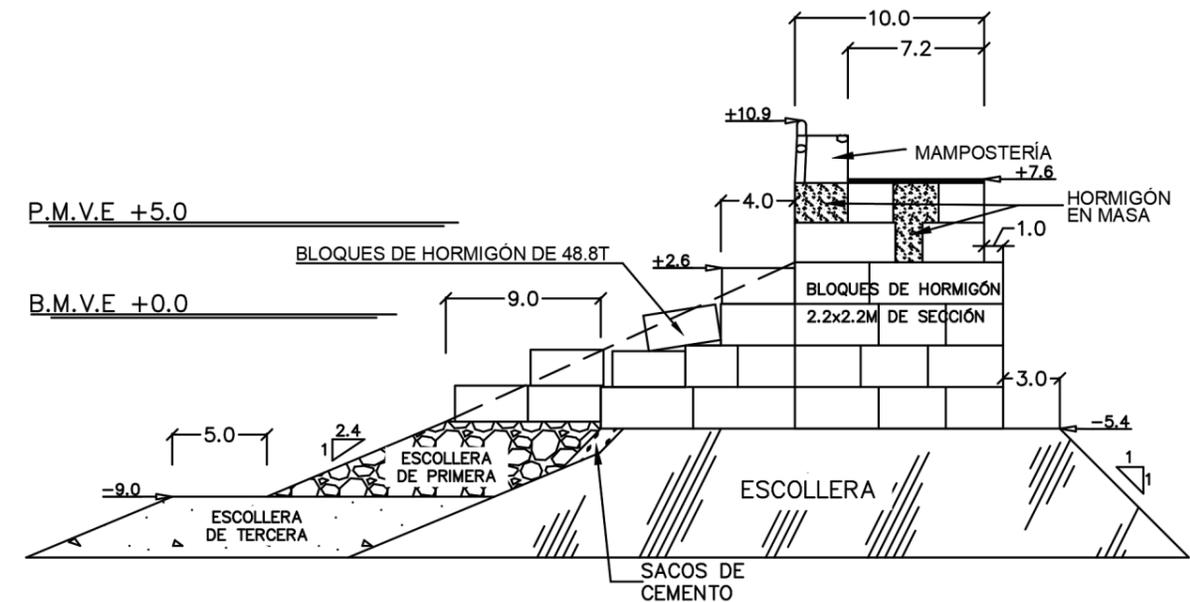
Sección tipo de refuerzo, 1964. Cotas en metros.
